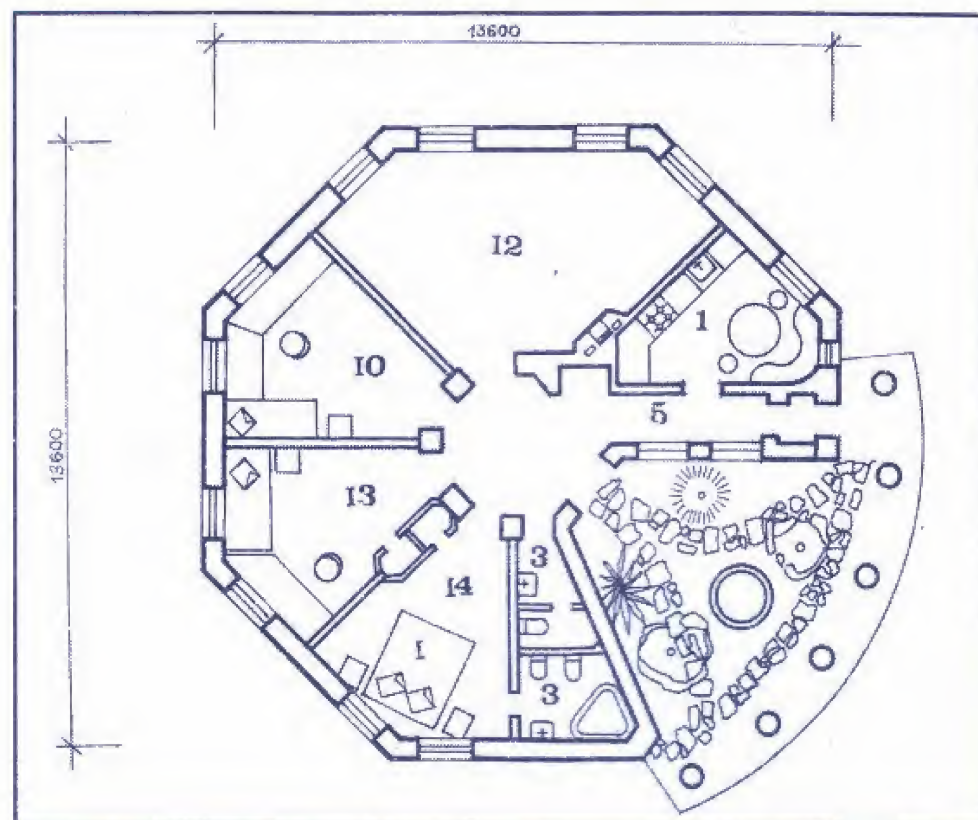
План першого поверху жилої будівлі з внутрішнім двориком
